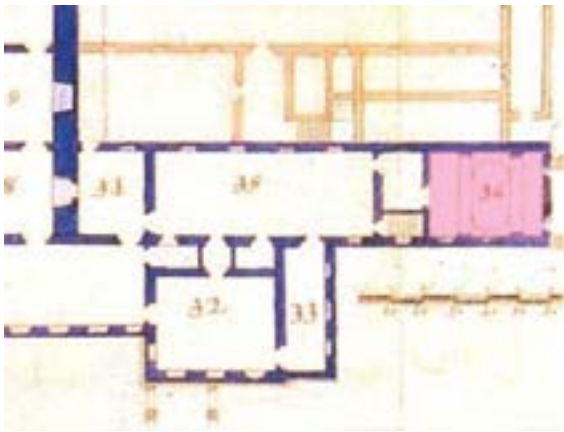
1705 ARDEMANS *Detalle de la planta del Alcázar
